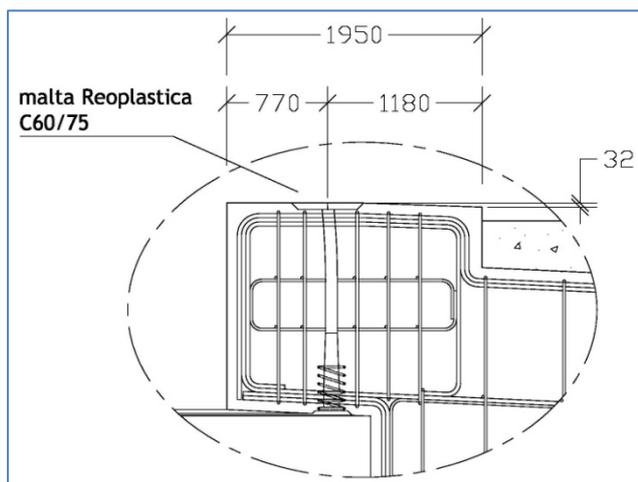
Sezione di interfaccia Torre-Plinto tipo
